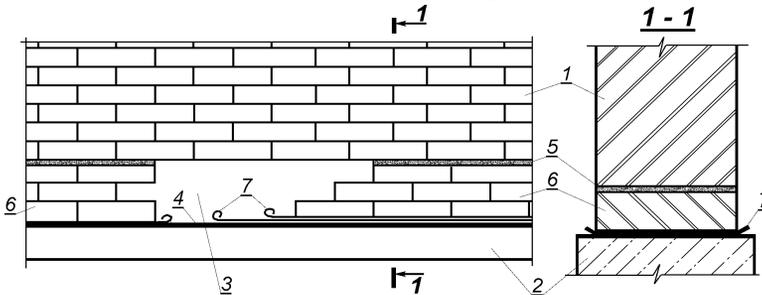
Замена или дополнительное устройство гидроизоляции:
